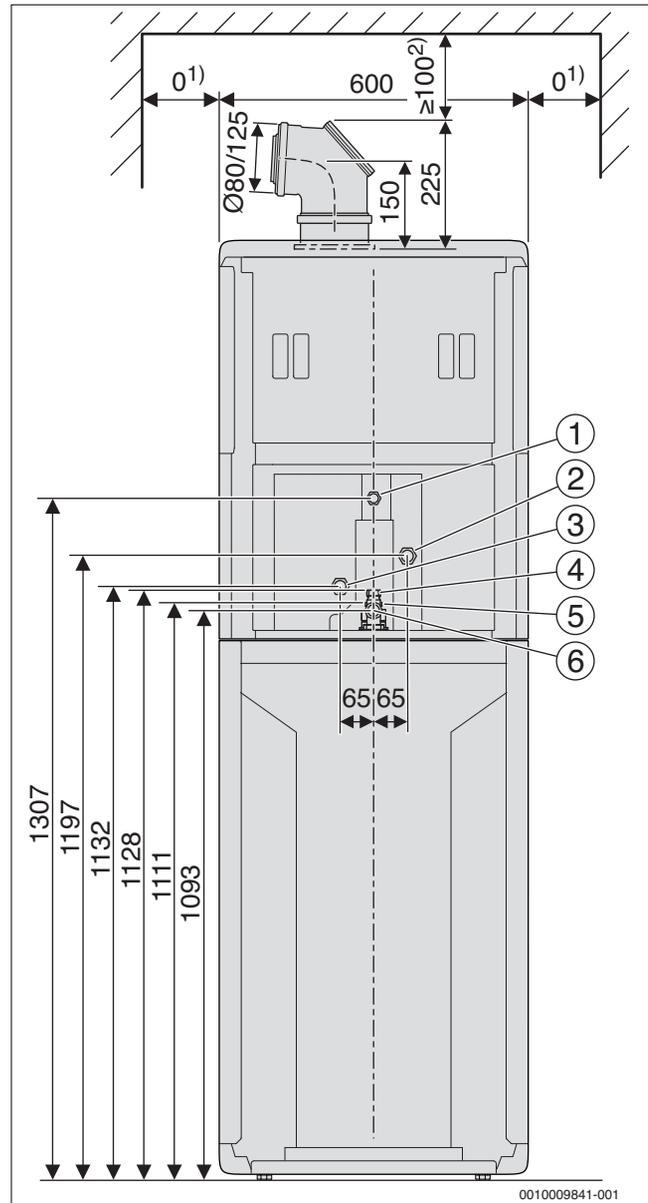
Abmessungen und Anschlüsse ohne Zubehör, Rückansicht, (Maße in mm)
